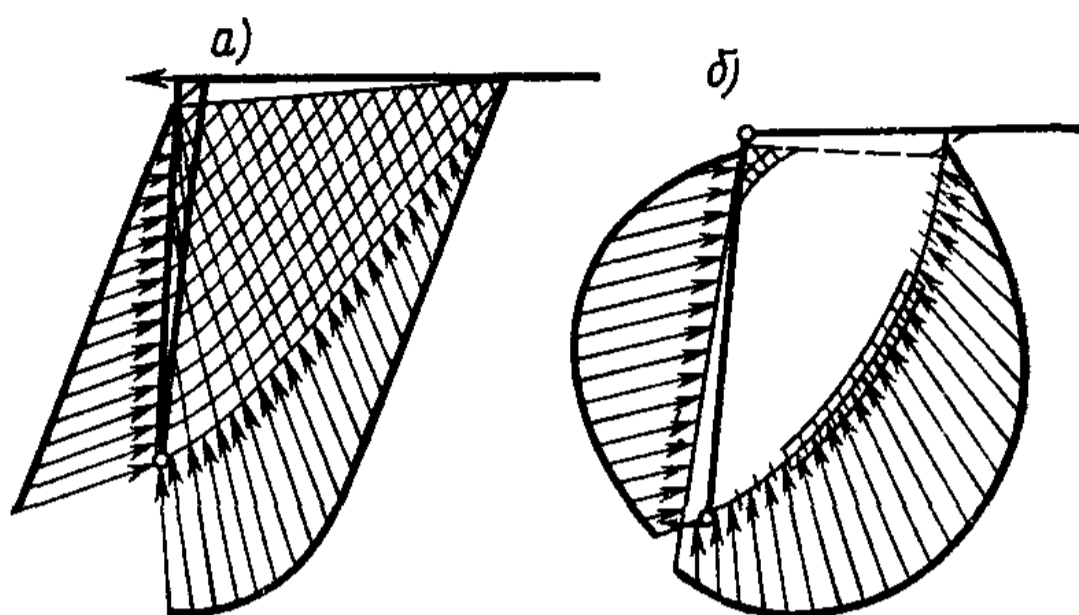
Эпюры давления грунта на стенку при ее вращении:
